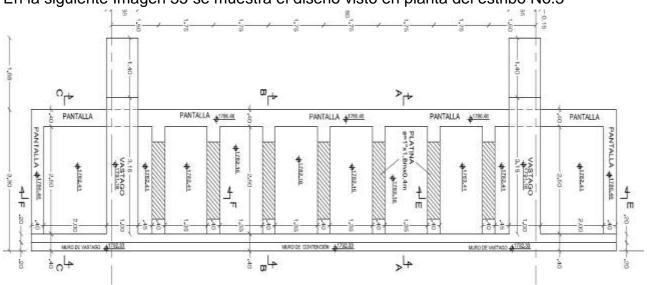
PLANTA DE CIMENTACION ESTRIBO No.3
